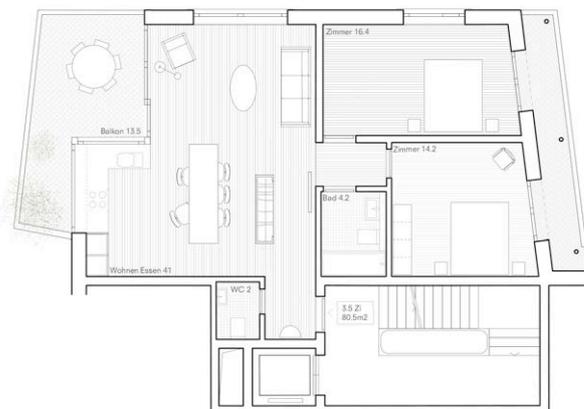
Grundriss 3.5 Zimmer Wohnung
